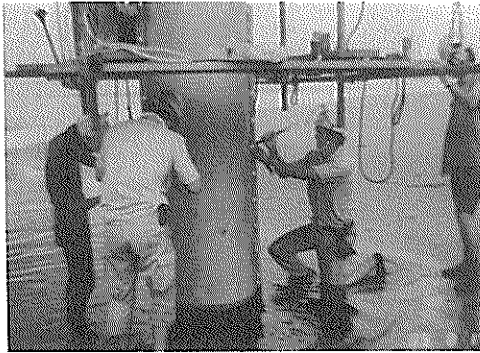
防食シート接着ライニング工法の作業状況（杭No.1）
